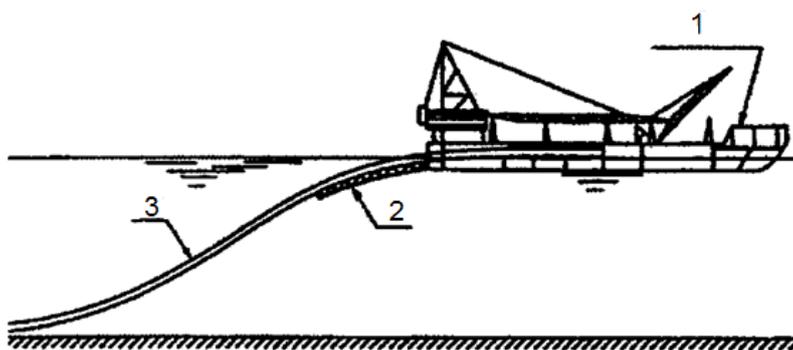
Укладка подводного трубопровода на дно моря S-методом:
